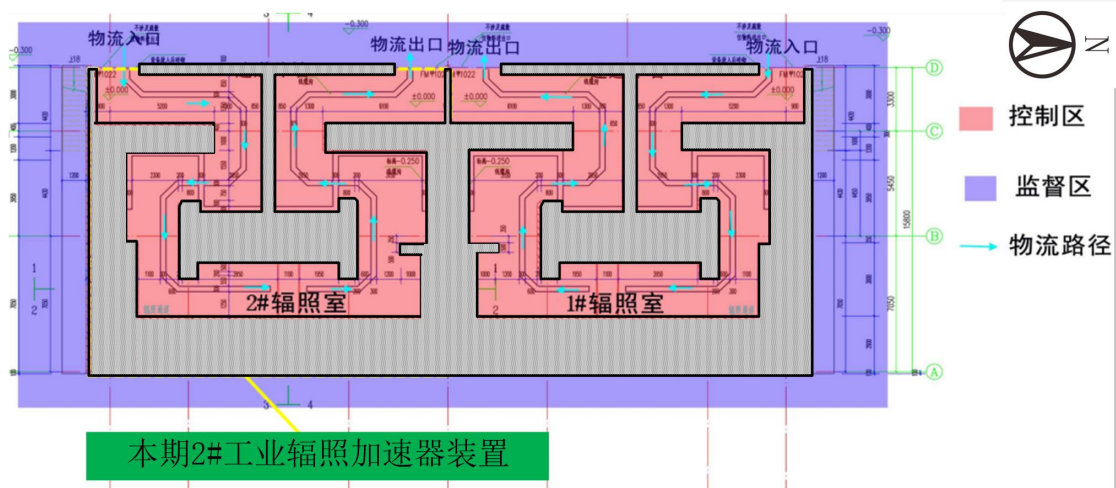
2#工业辐照加速器装置一层辐照室平面布置示意图
